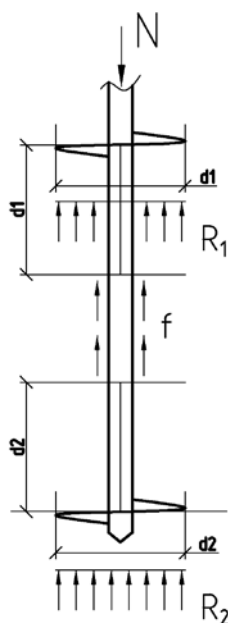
Предлагаемая расчетная схема для доработки методик расчета применительно к широколопастным винтовым сваям с двумя и более рабочими лопастями. Обозначения соответствуют рис. 3
